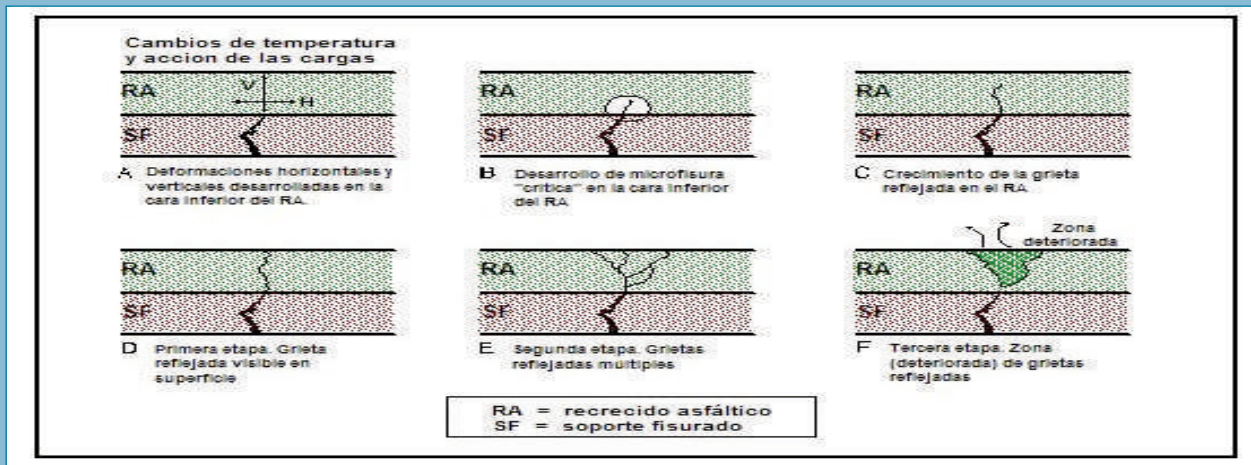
Esquema del proceso de la reflexión de las fisuras y las grietas
